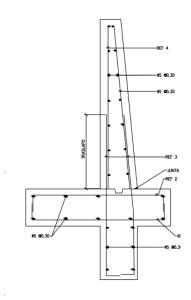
Sección Transversal Típica de Muro de Contención. Fuente: CIU.
